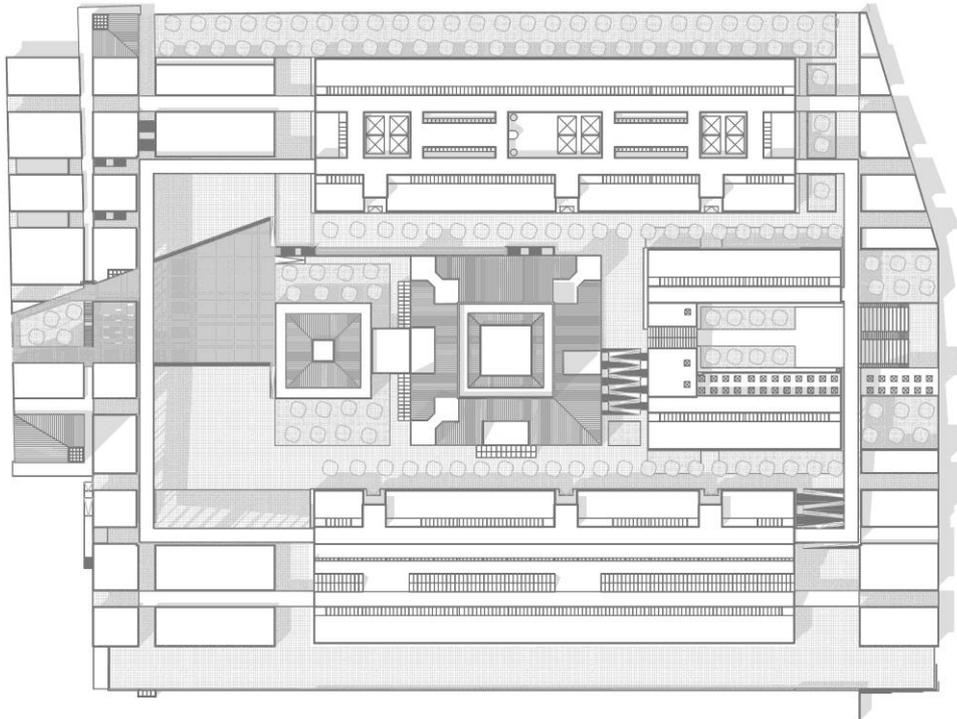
Planta de Cobertura da Faculdade de Arquitectura
